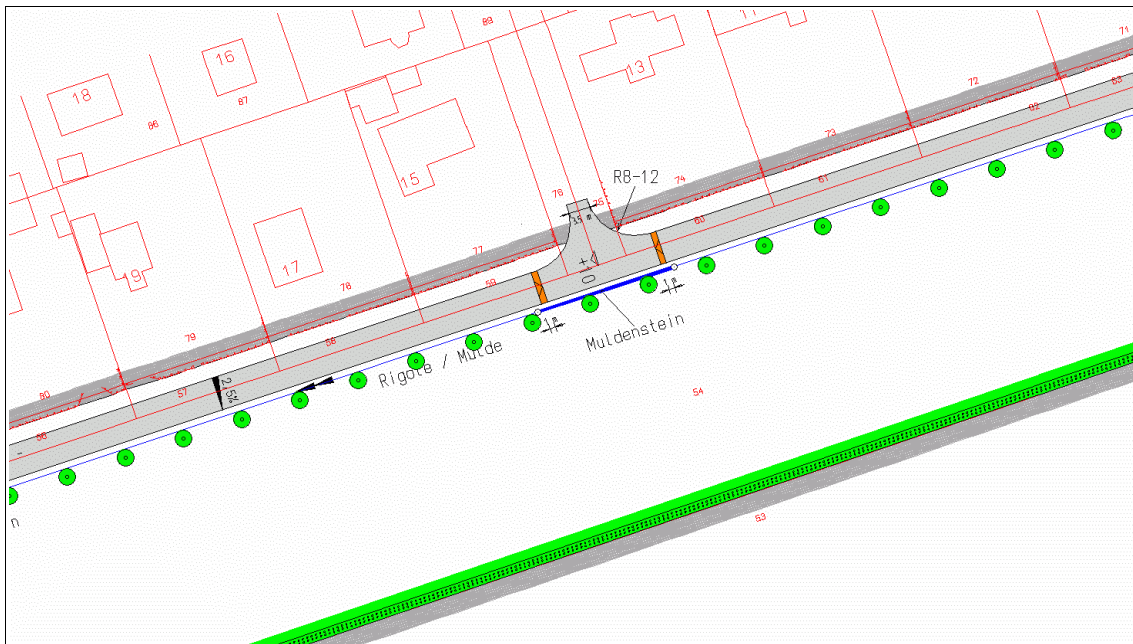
Straßenentwässerung (Plangebetsausschnitt, schematische Darstellung)
